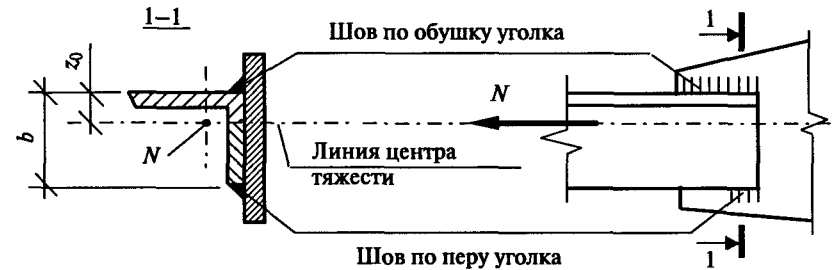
Прикрепление угловыми сварными швами уголка
